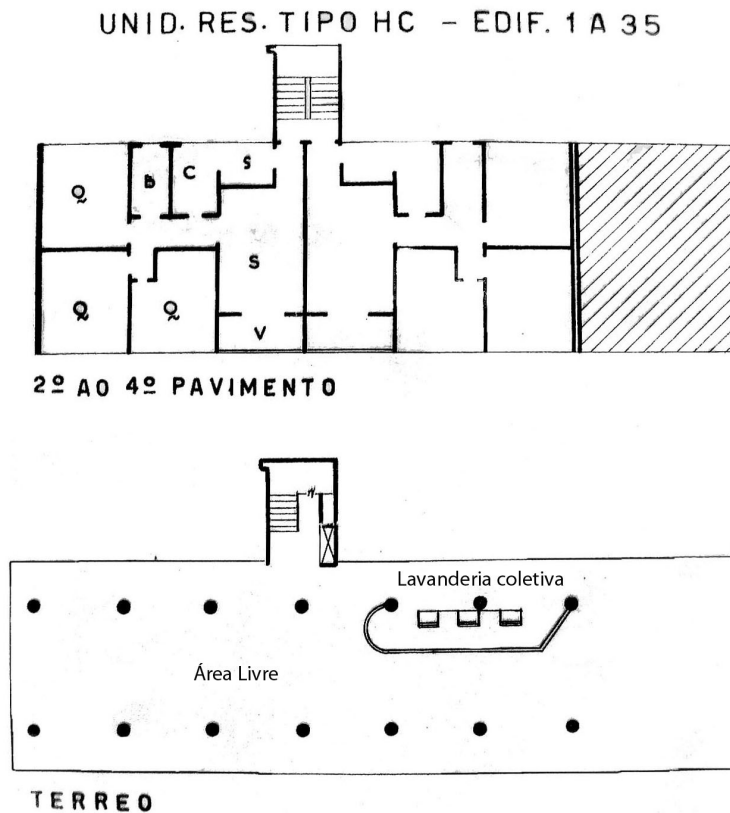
Esquema da planta da unidade HC. Fonte: Arquivo INSS.
